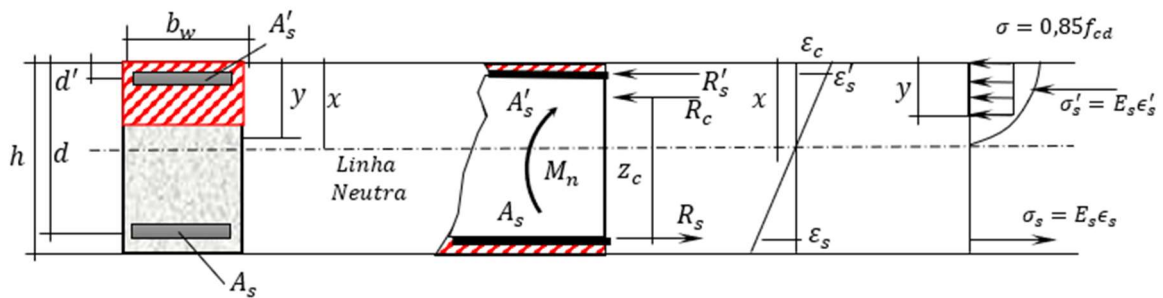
Determinação do momento resistente de vigas de concreto armado (LEITE; GOMES, 2021)
